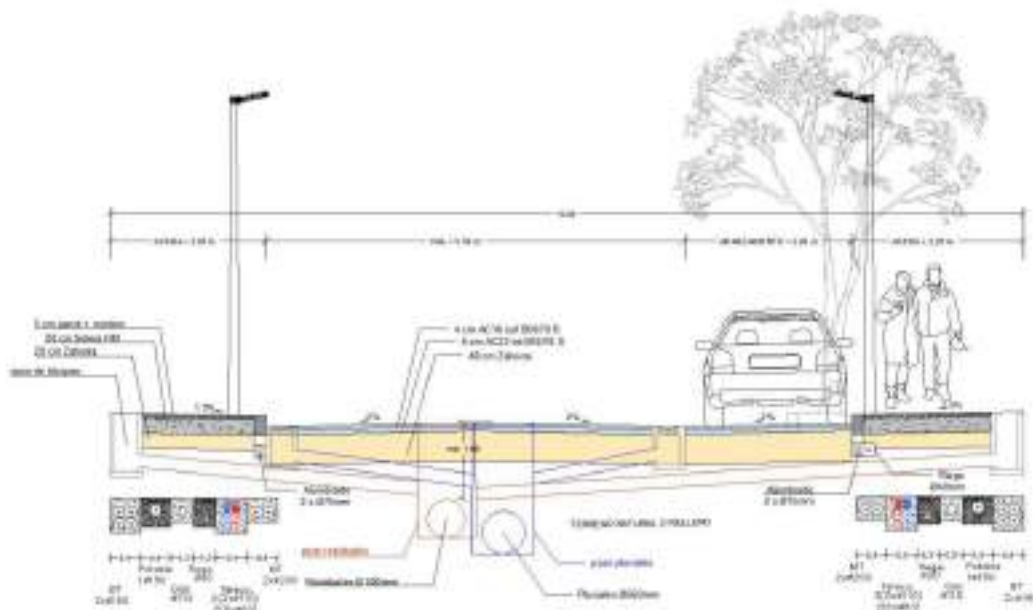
Sección tipo 2. Vial de 12,00 m de anchura
